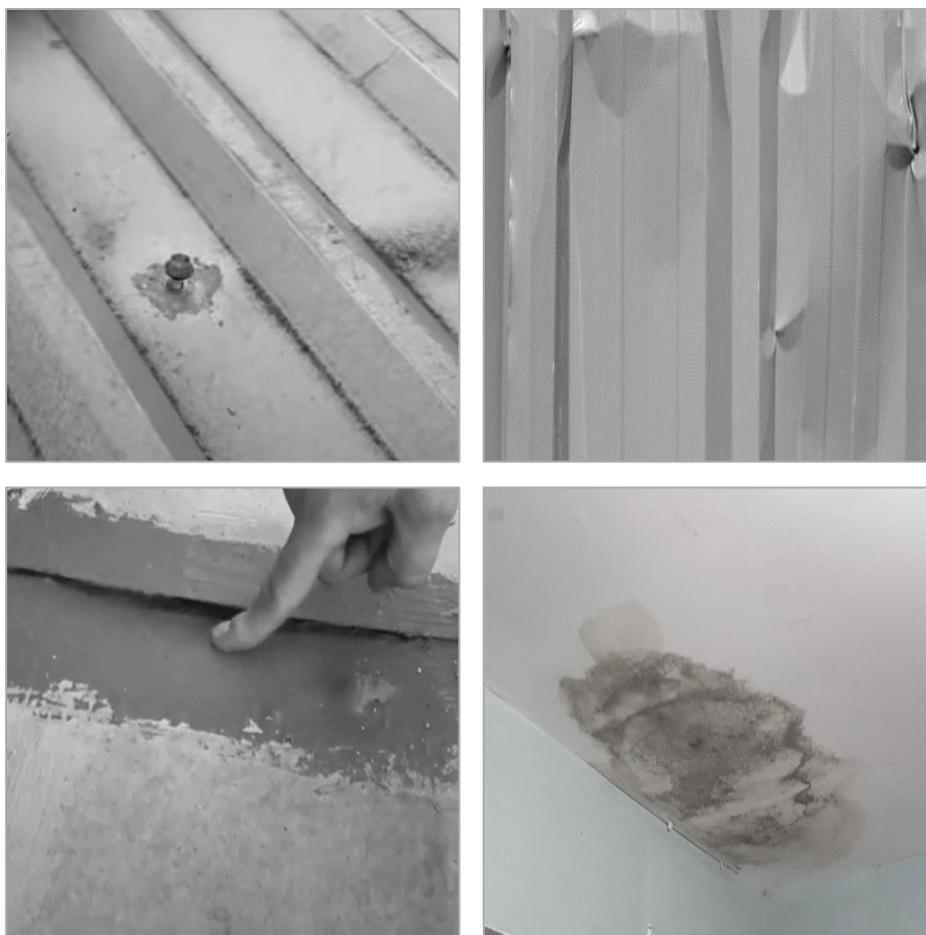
Defectos de construcción de cubiertas de techo
